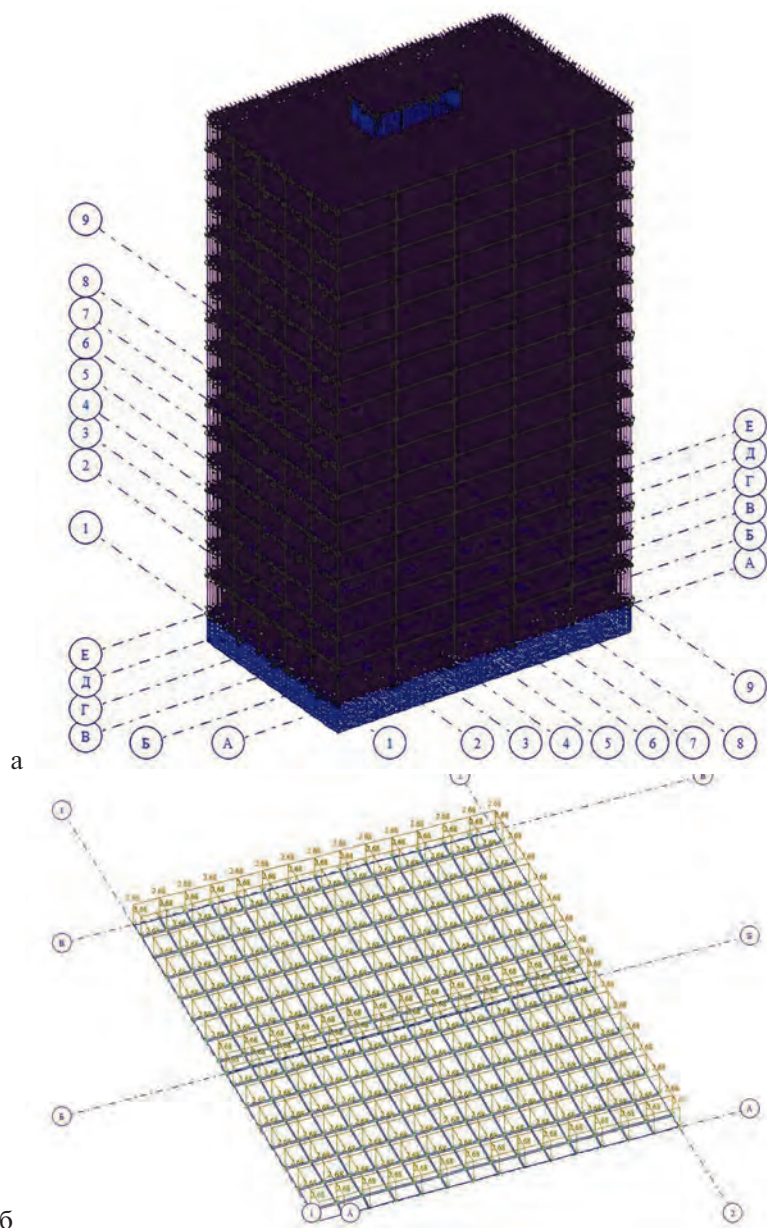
Загрузка № 3. Нагрузка на всю расчетную схему (а) и фрагмент перекрытия с равномерно распределенной нагрузкой (б)
